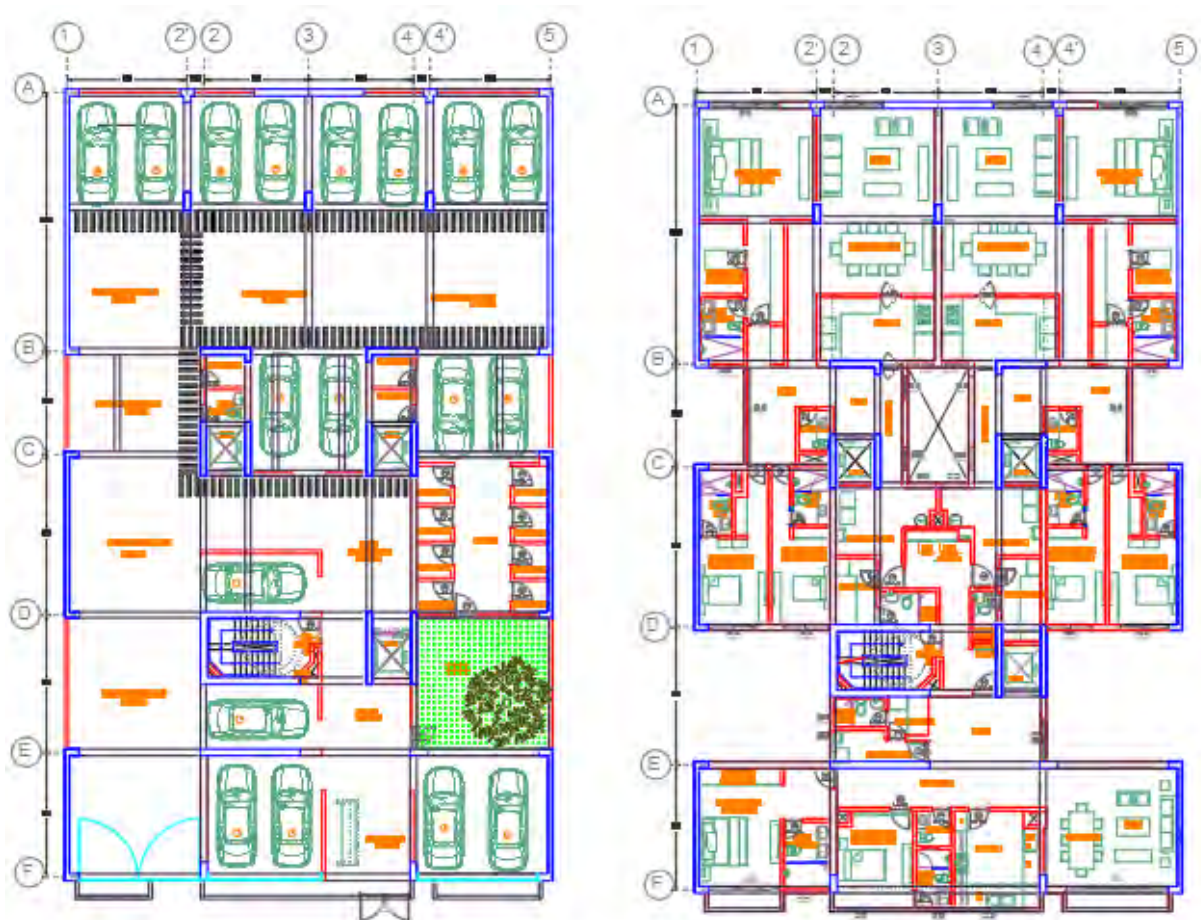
Planta del primer piso y piso típico (Izq. a Dcha.).
